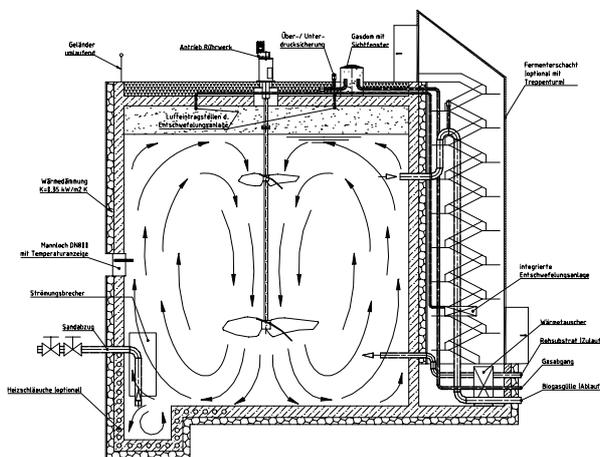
Axialrührwerk; Zeichnung: ENTEC Environmental Technology Umwelttechnik GmbH
